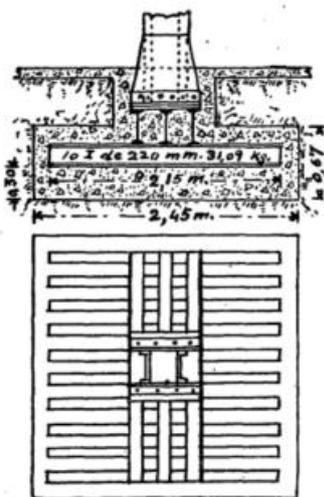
Losa de hormigón armado con ensanchamiento en la base (Fernández, 1934)
